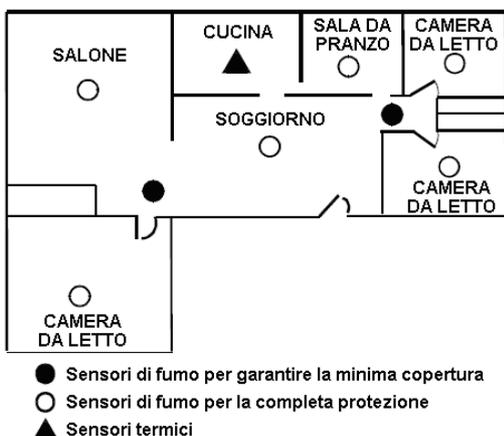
Posizionamento rilevatori ottici/termici in un appartamento disposto su un piano con due zone notte
